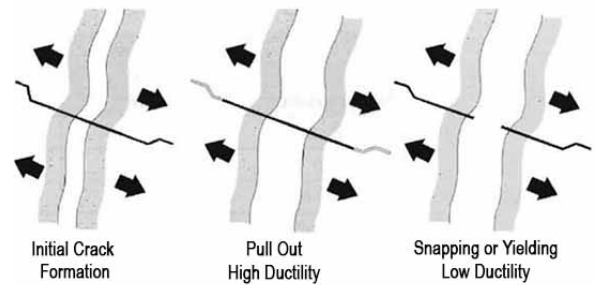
Mecanismos de falla post-agrietamiento para hormigón reforzado con fibra de acero con enganchado (Bernard, 2008).
